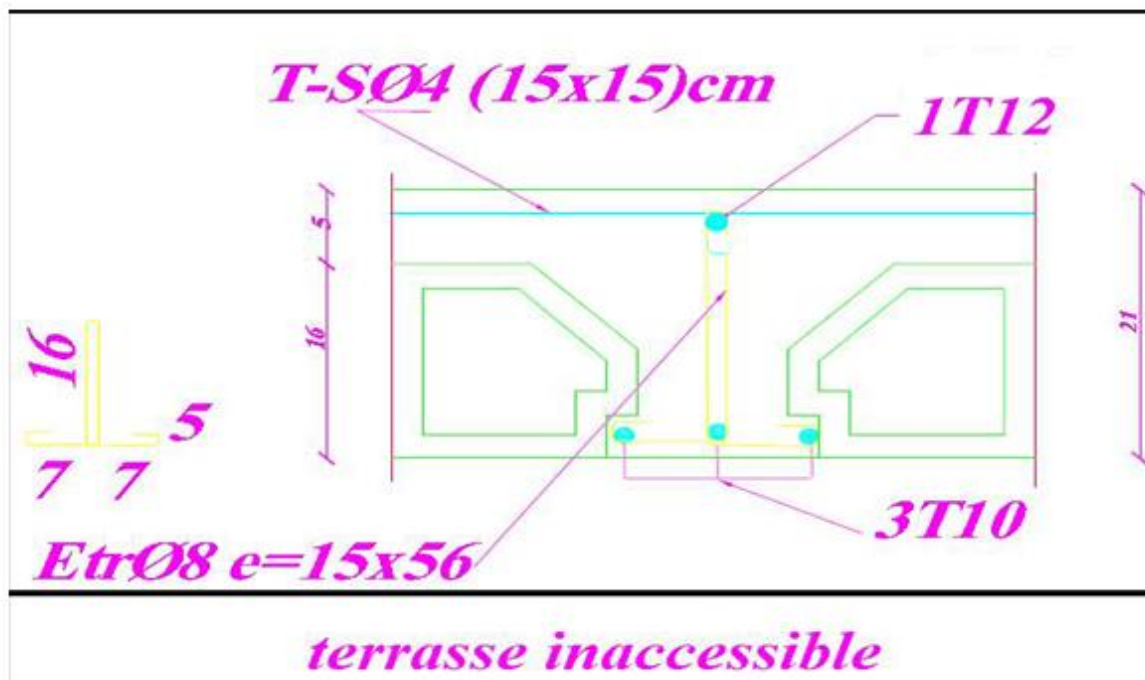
Disposition constructive des armatures dans la poutrelle (terrasse)
